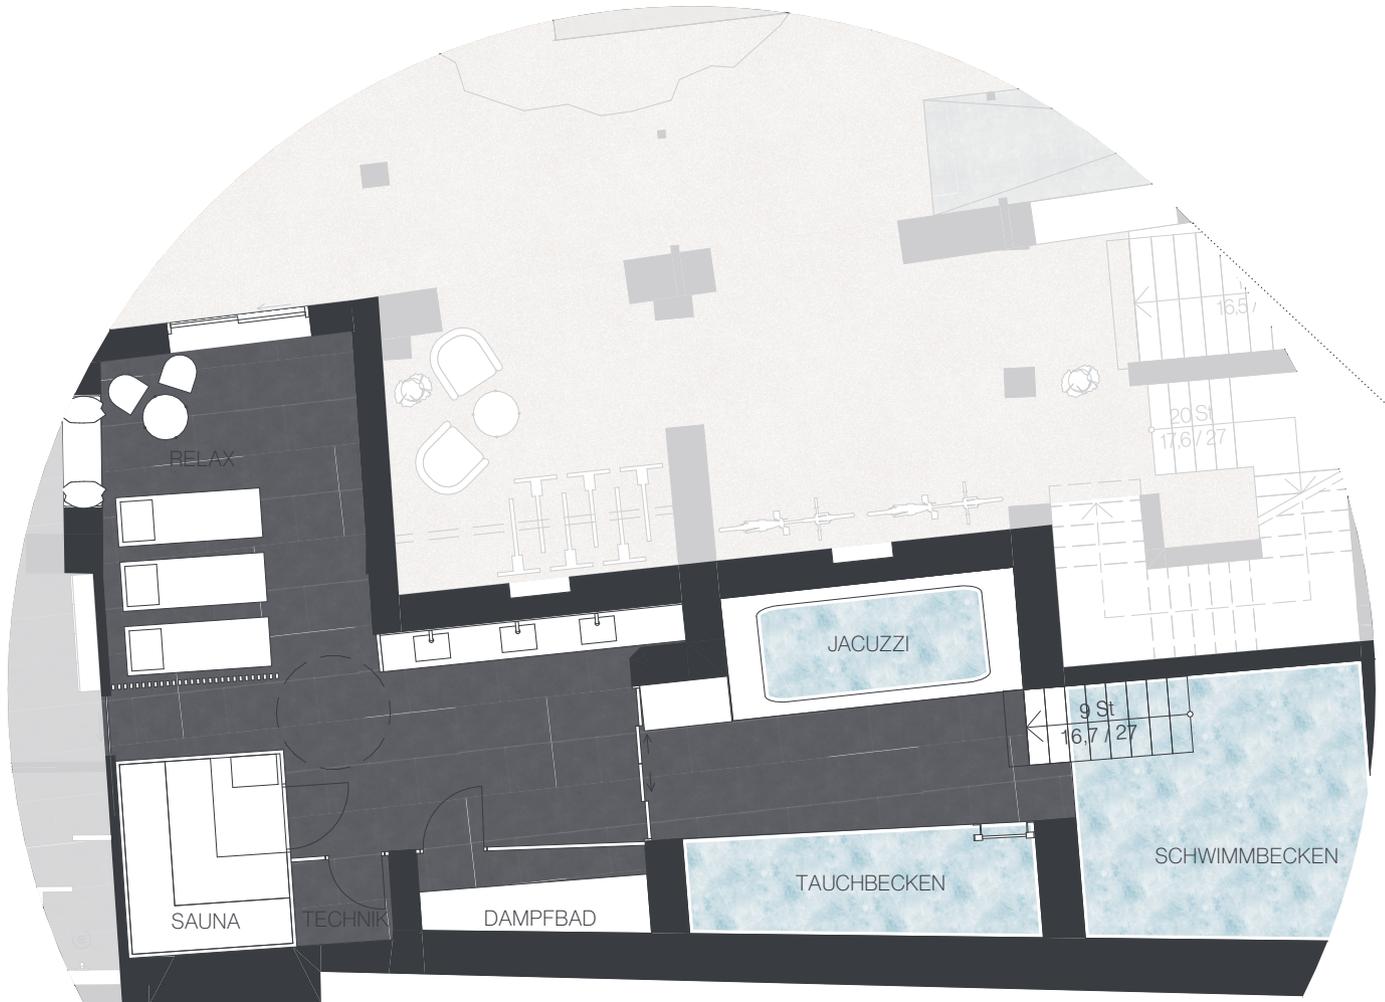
| Grundriss Erdgeschoss. Fitness
